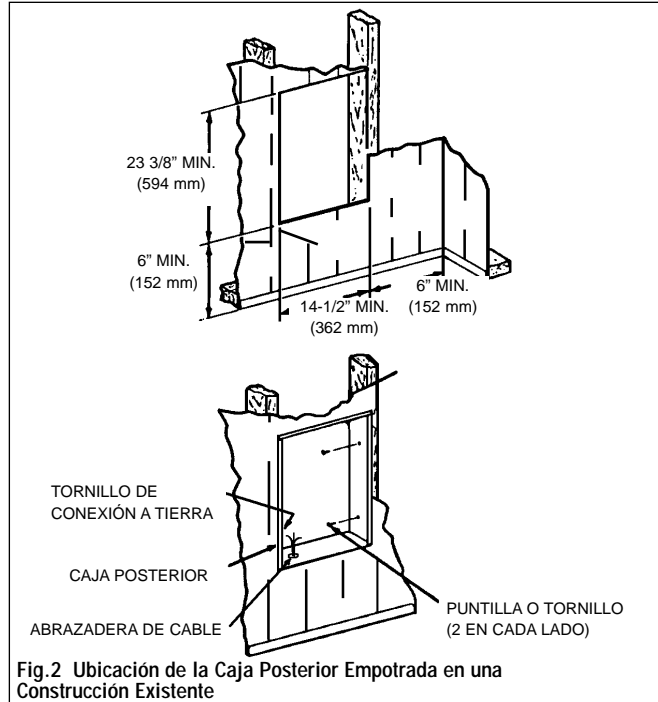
Ubicación de la Caja Posterior Empotrada en una Construcción Existente
